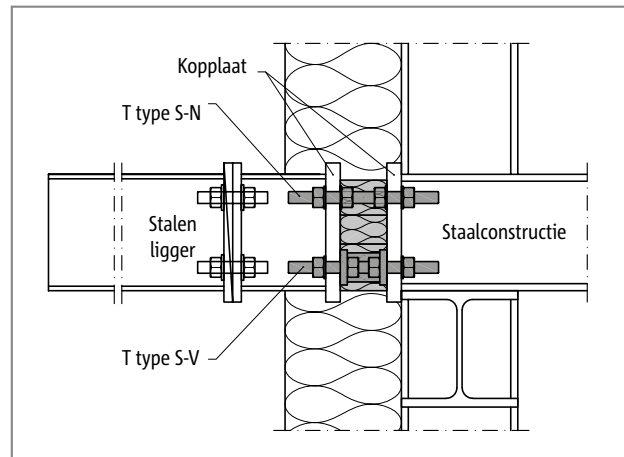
Schöck Isokorf® T type S-V: ondersteunde staalconstructie
